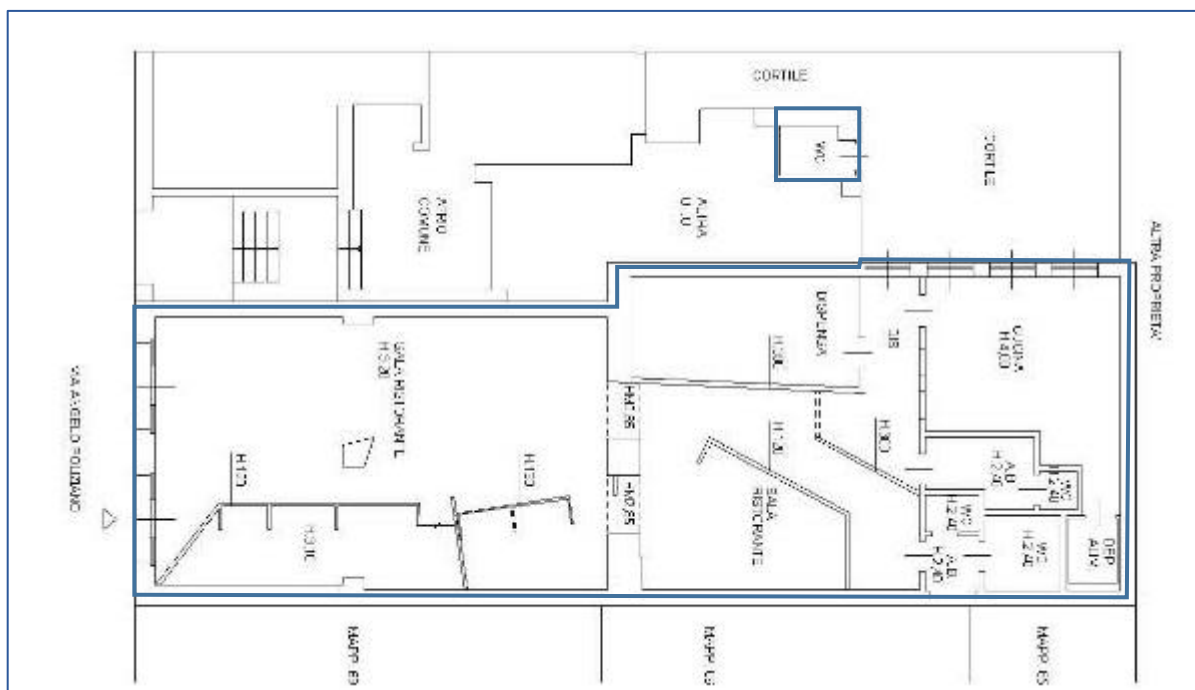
Estratto planimetria catastale negozio con wc esterno
